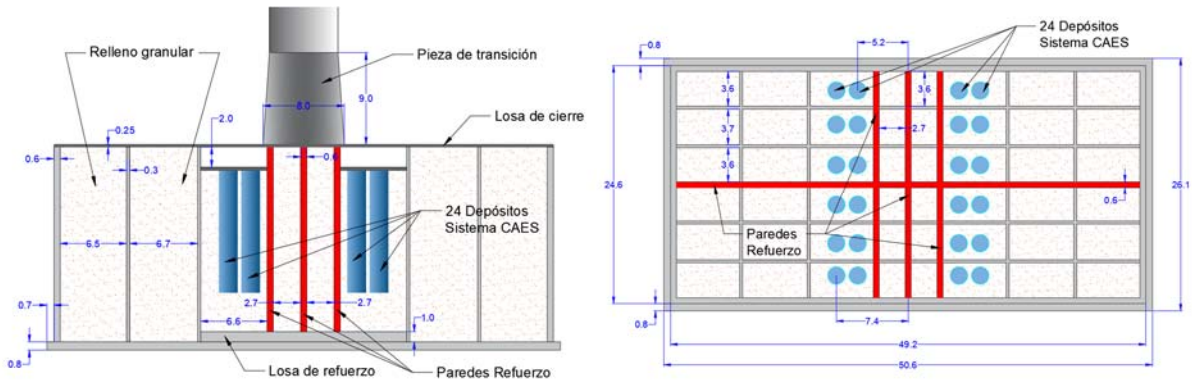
Definición en alzado y planta del nuevo diseño de cajón tipo
